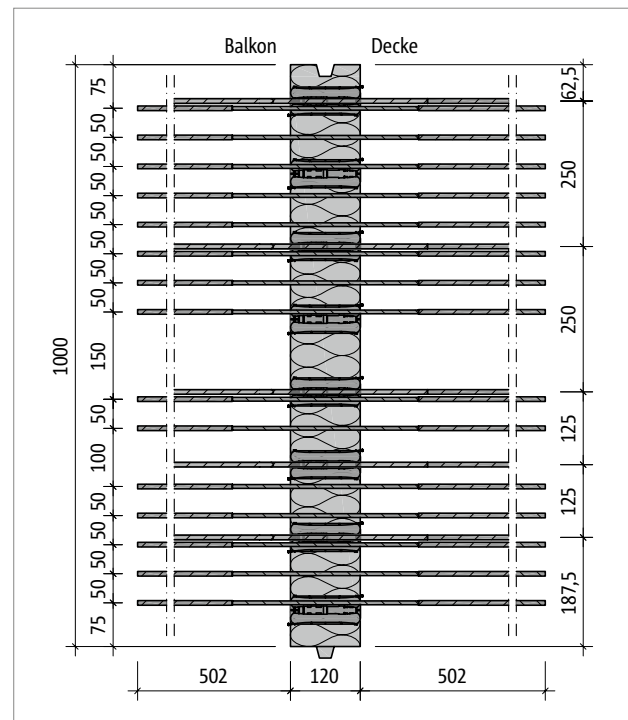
Schöck Isokorb® XT Typ KL-M6: Produktgrundriss
